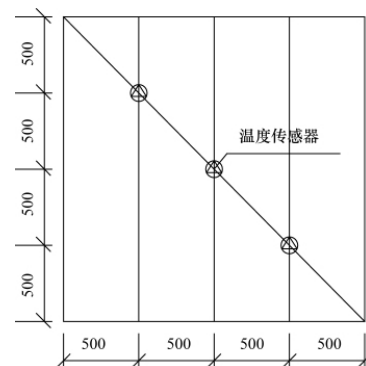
竹结构墙体内温度传感器安装平面图(单位:mm)
